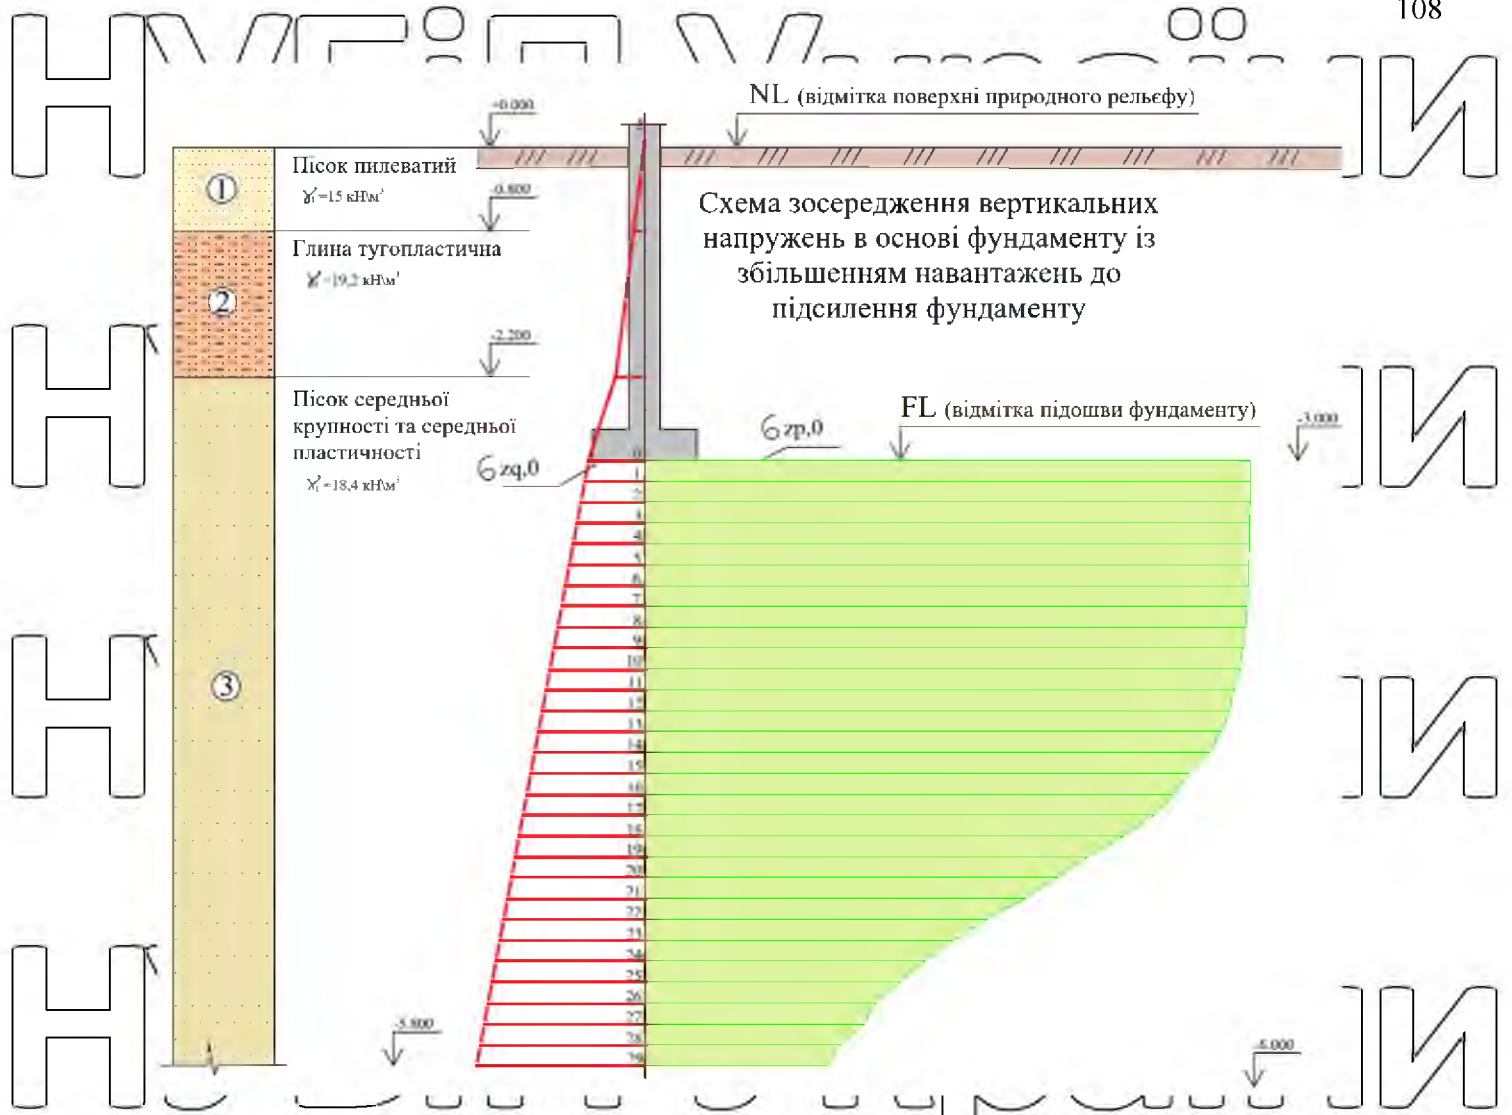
Схема напружень в основі фундаменту до підсилення при збільшені навантаження від реконструкції
